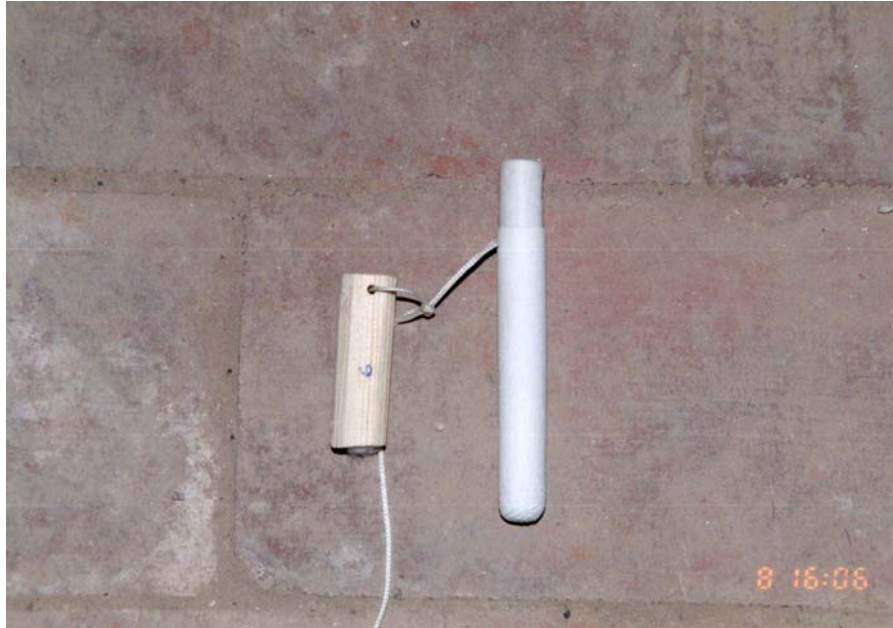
Prüfkörper vor ihrem Einbau im Mauerwerk.
